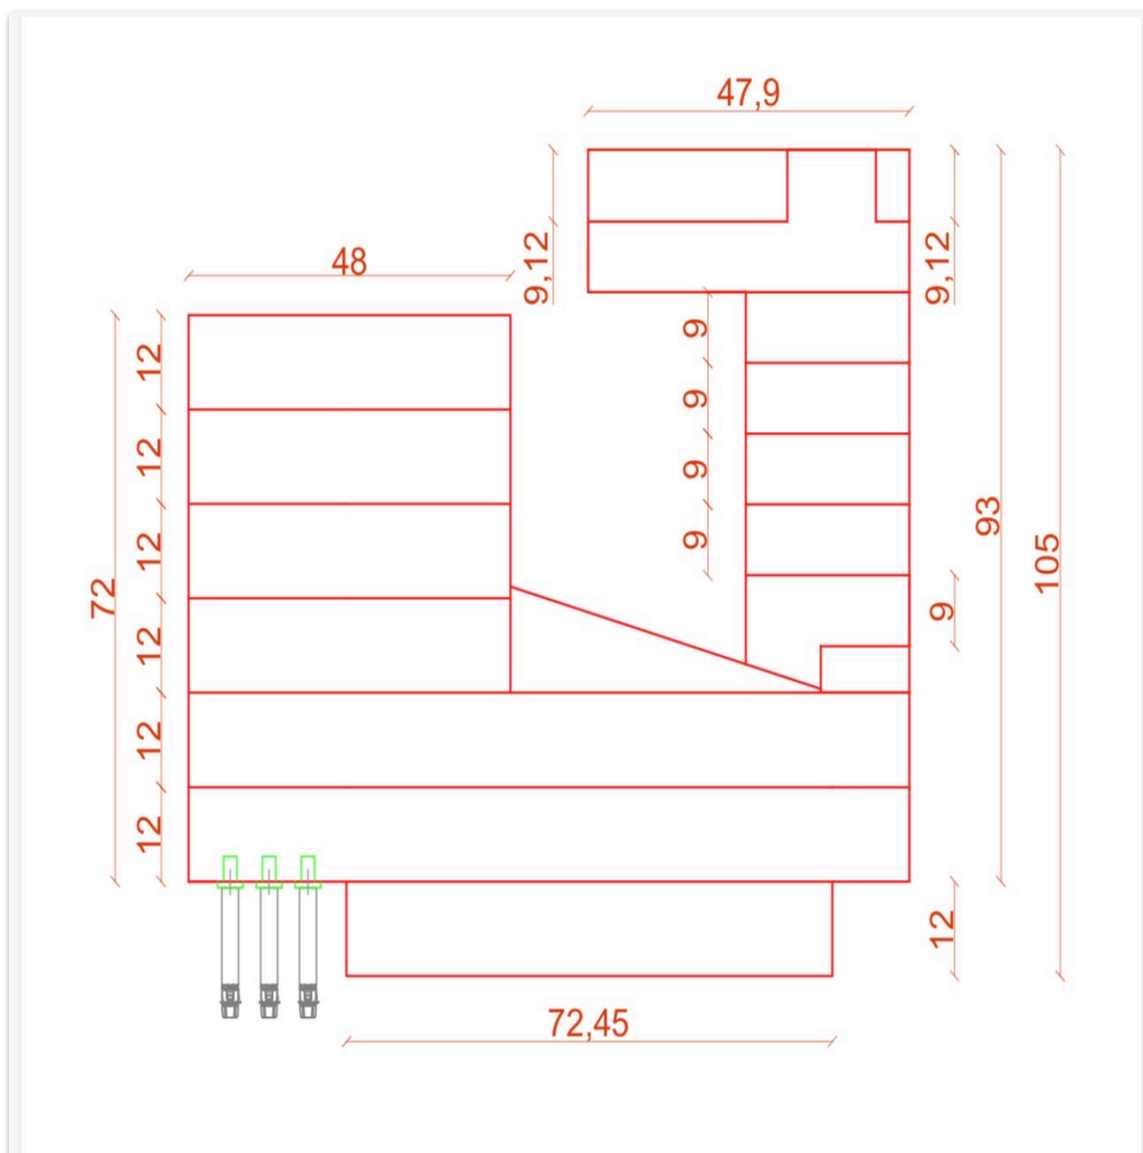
Pianta della porzione di stabilimento in oggetto con quotatura (m)
